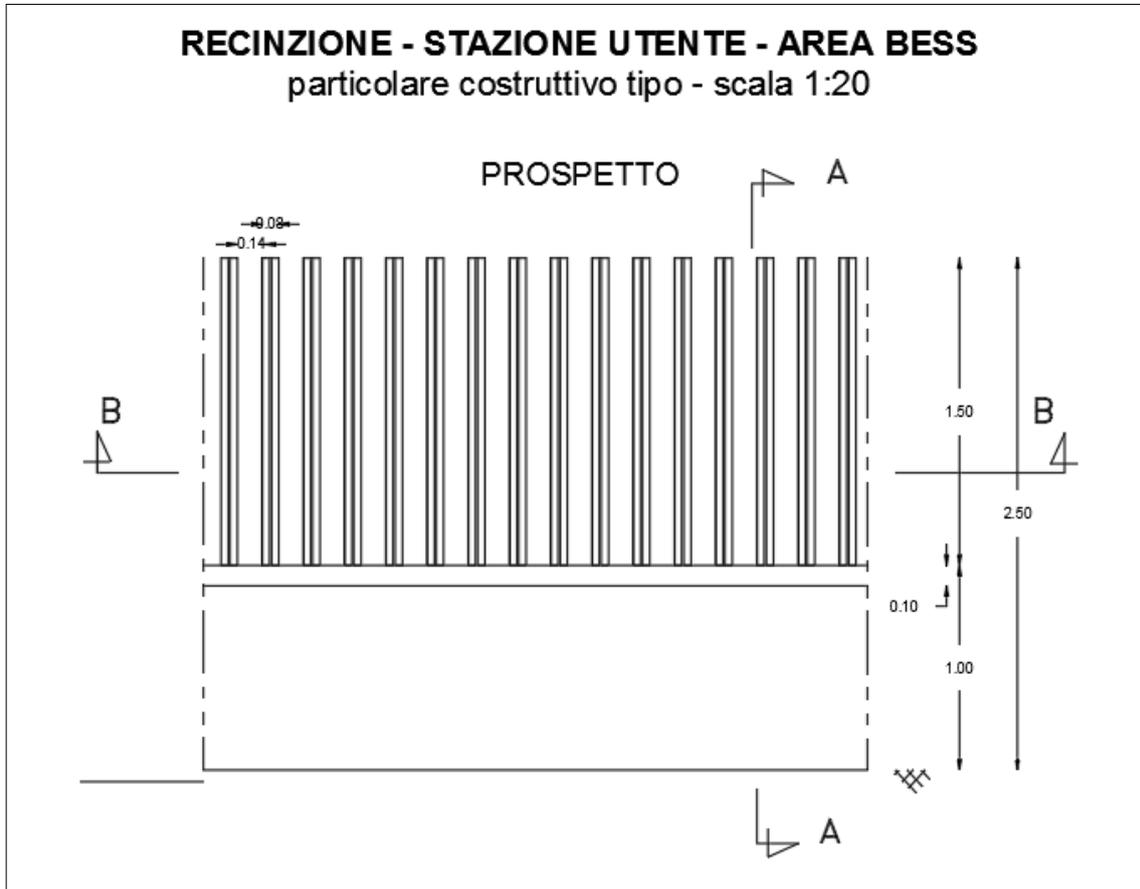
Tipologico -Prospetto Recinzione Area BESS e Area SSU
